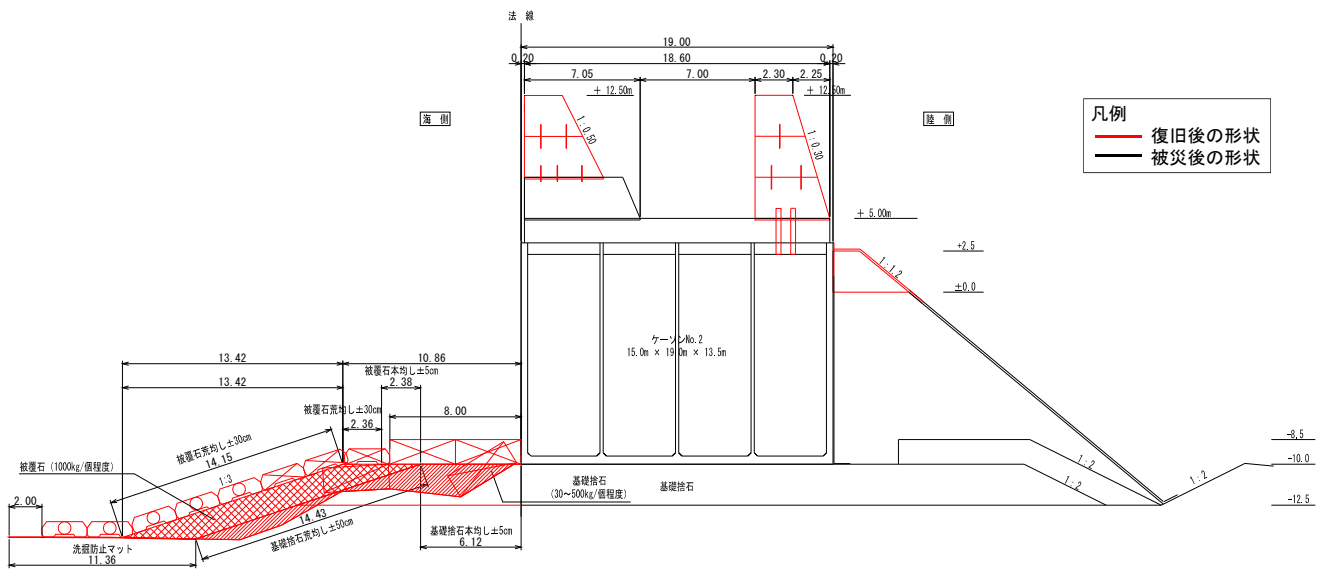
No.1 外港地区防波護岸断面図(復旧後)
